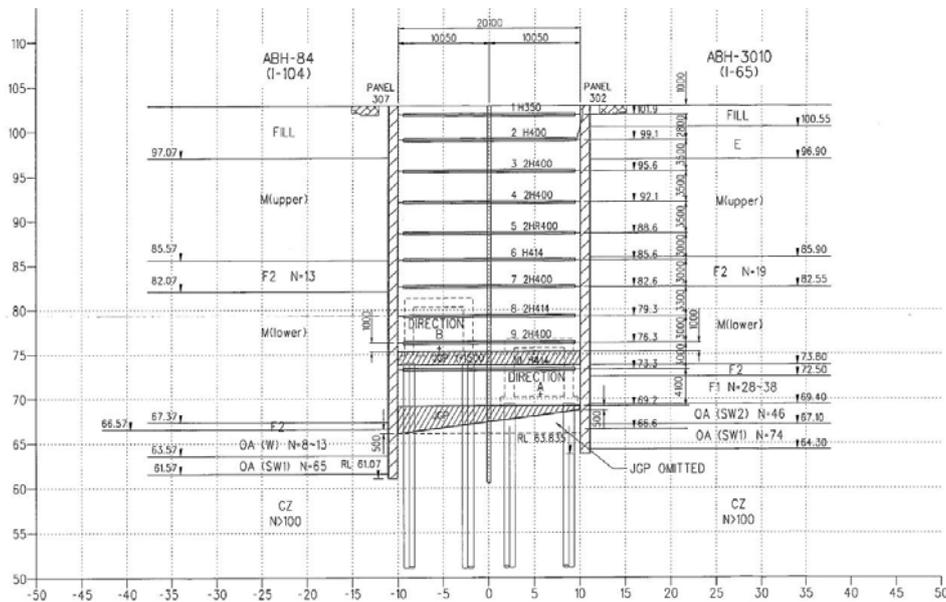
Sección de la excavación involucrada en el colapso, con los distintos estratos indicados. La arcilla marina blanda está indicada con la letra M. El colapso se produjo durante la excavación para instalar la décima fila de puntales
